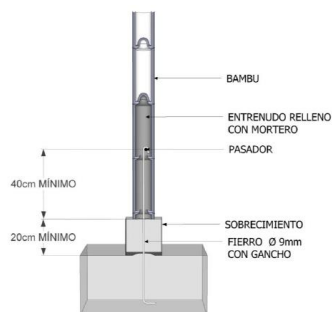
Fundação 1 - (Ministerio de Vivienda, C.y.S.d.P., 2012)
